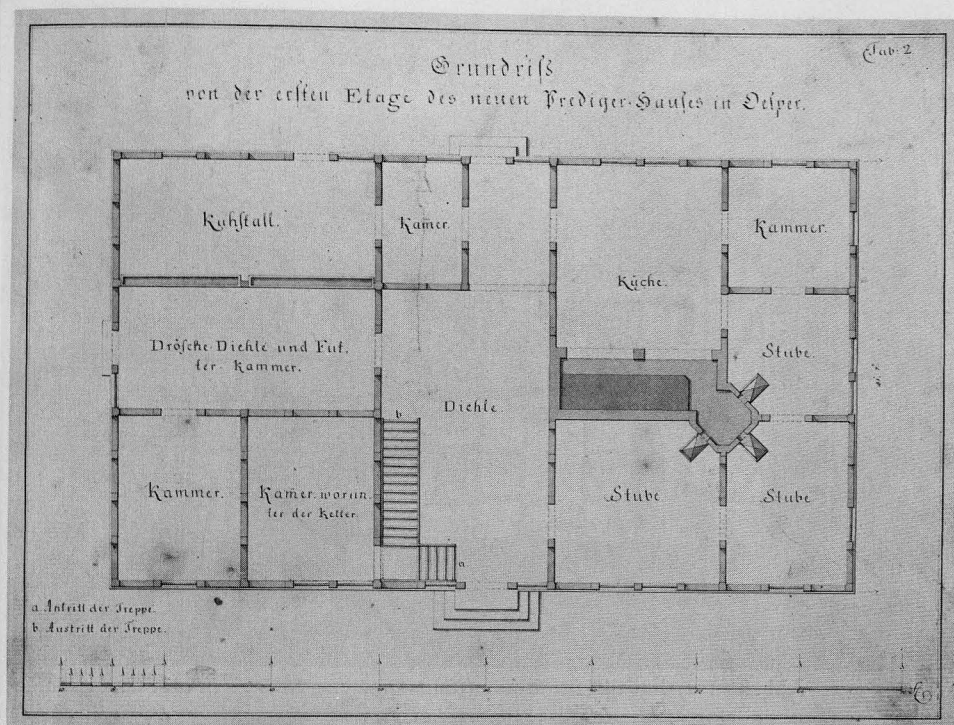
Grundriß des Erdgeschosses des Pfarrhauses in Olper
